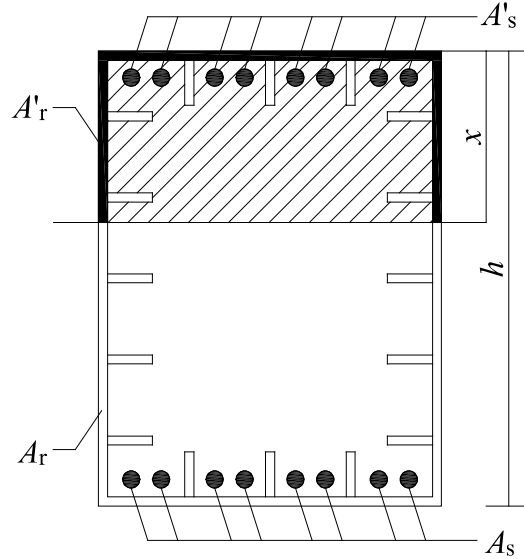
钢壳混凝土组合桥塔压弯承载力计算示意图
